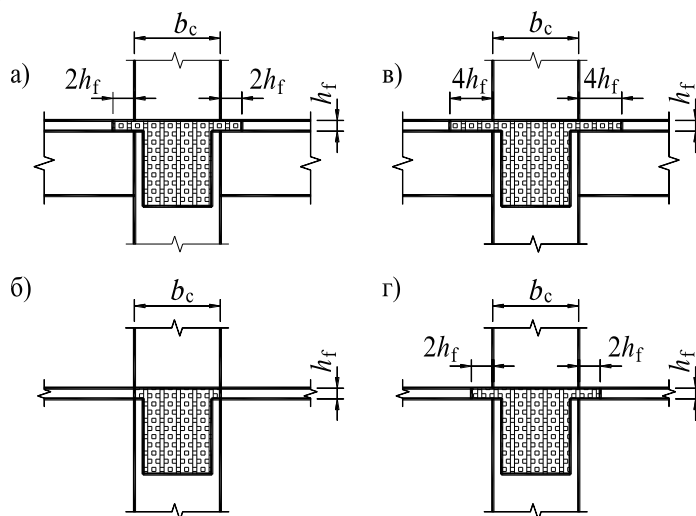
Эффективная ширина полок (b_{eff}) балок, жестко закрепленных в колоннах
